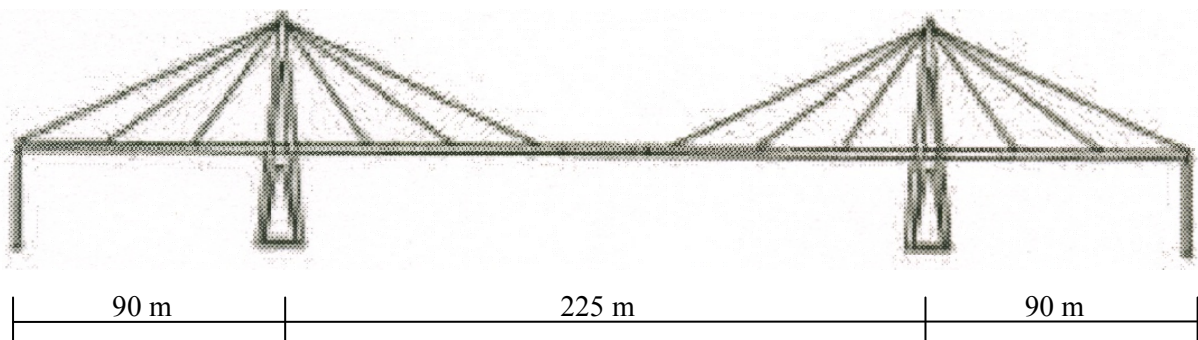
Vue en élévation du pont Figueira da Foz Bridge (Portugal)
